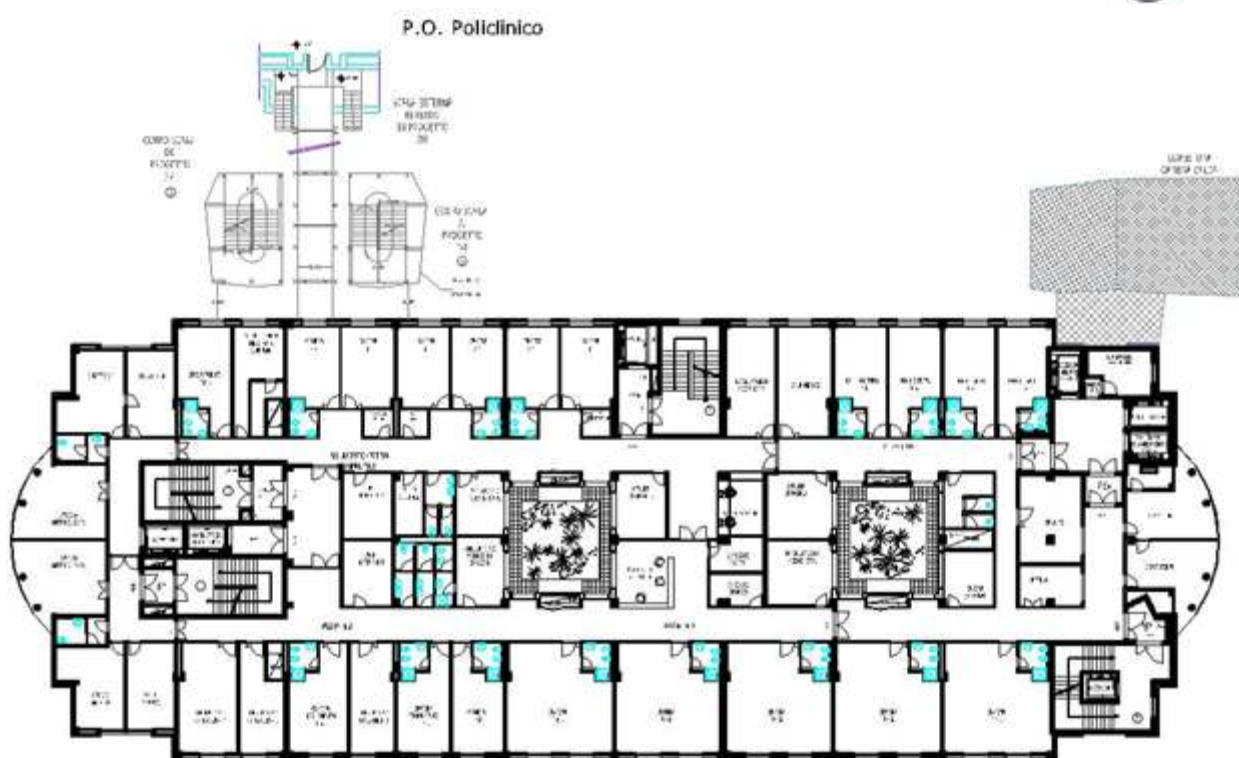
Planimetria Piano Primo - livello +3,50.
